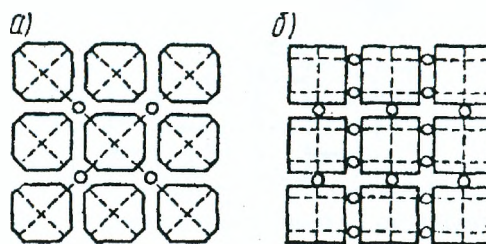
Конструкция гибких покрытий из бетонных плит: а – с диагональными связями и кольцевыми соединениями; б – с поперечными и продольными связями и петлевыми соединениями
